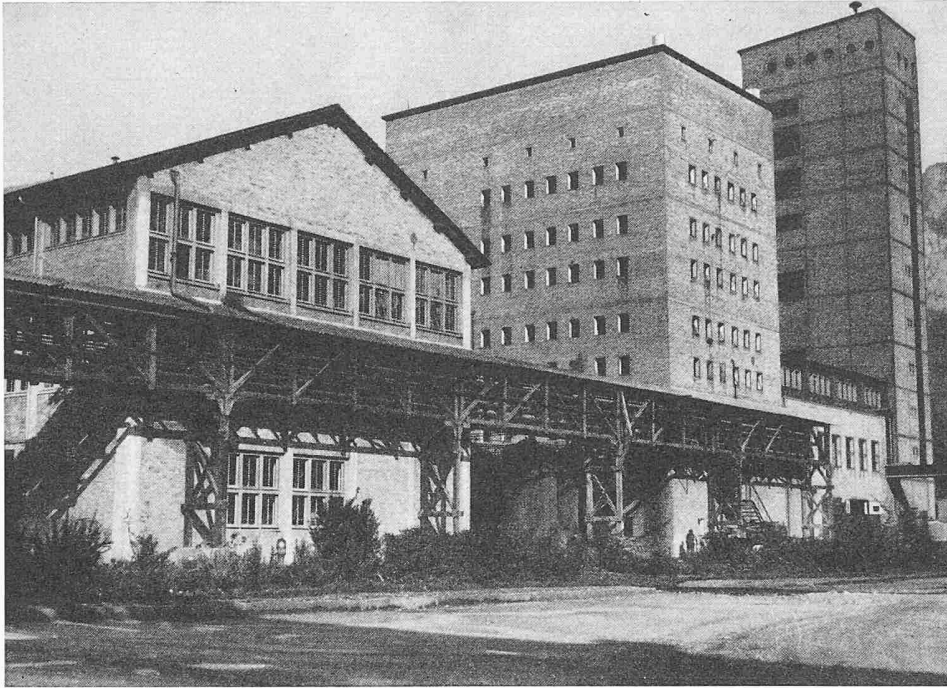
Für die in Ems angewendete Bauweise typische Fabrikationsgebäude; links Gärung, anschliessend Destillation, dann Wärmestation, ganz rechts Perkolation, davor eine Rohrbrücke in Holzkonstruktion
